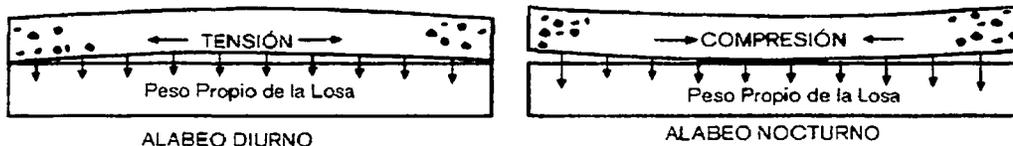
Alabeo de las losas de los pavimentos de concreto.
